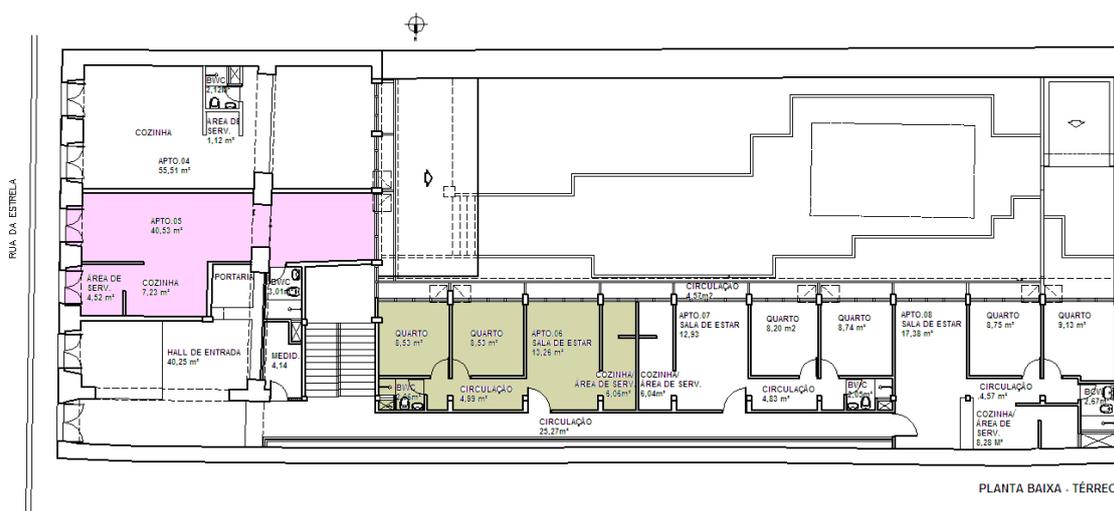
Ilustração de Planta Baixa de Pavimento Térreo
